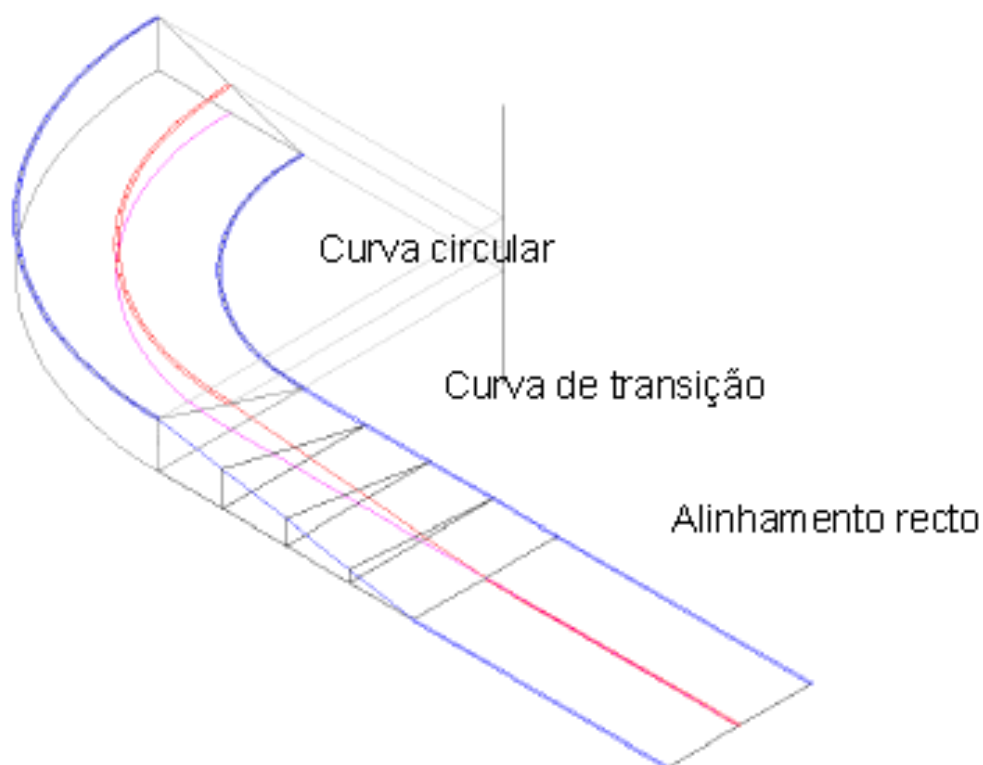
Elementos do traçado em planta (Fontul, 2024)
